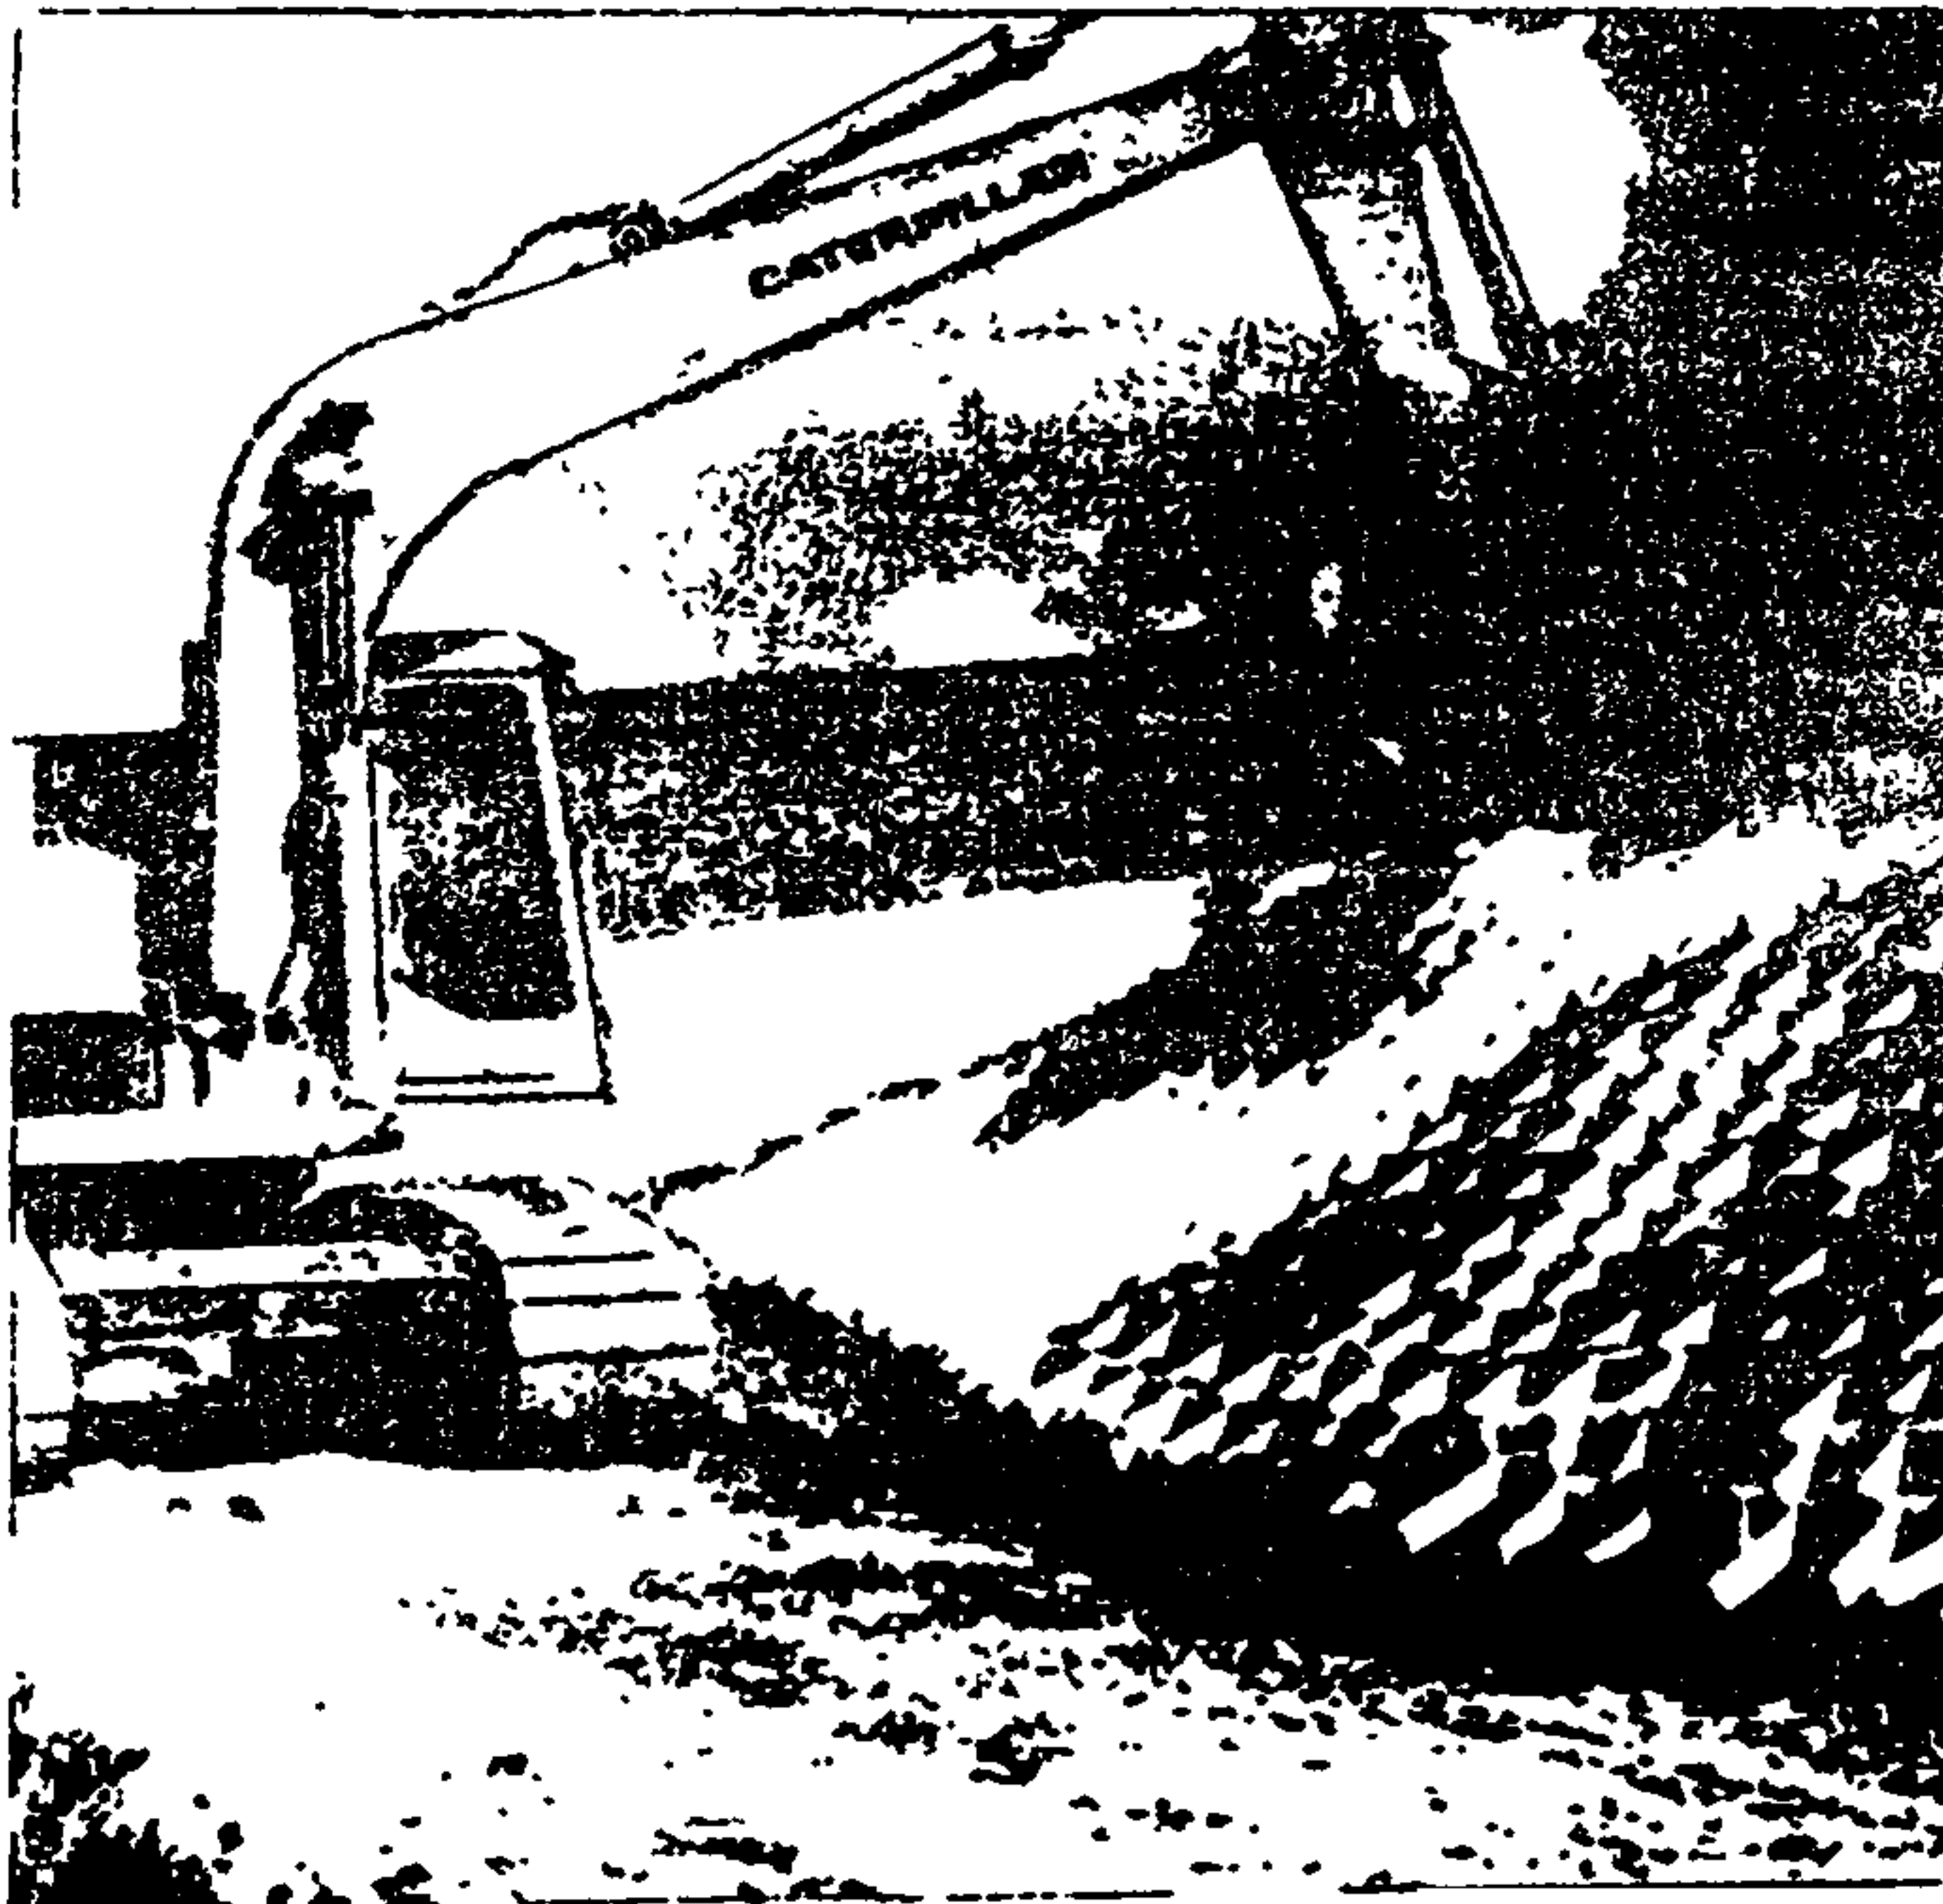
Засыпка георешеток типа Armatex растительным грунтом.
